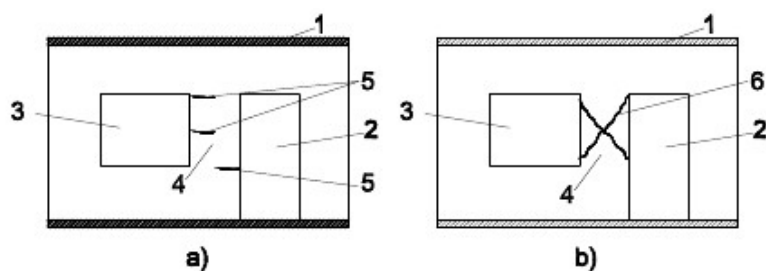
Fisuri în zonele cu buiandrugii.
